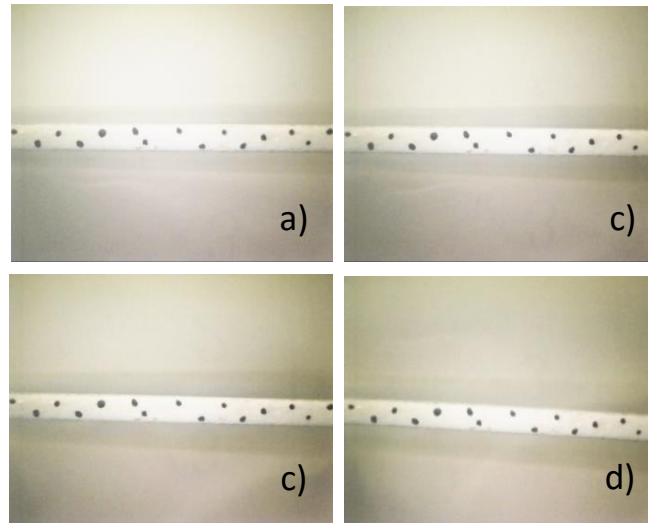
Viga de aço com pontos pequenos e afastados. a) imagem de referência; b) viga com carregamento de 1Kg; c) viga com carregamento de 2kg; d) viga com carregamento de 5kg.
